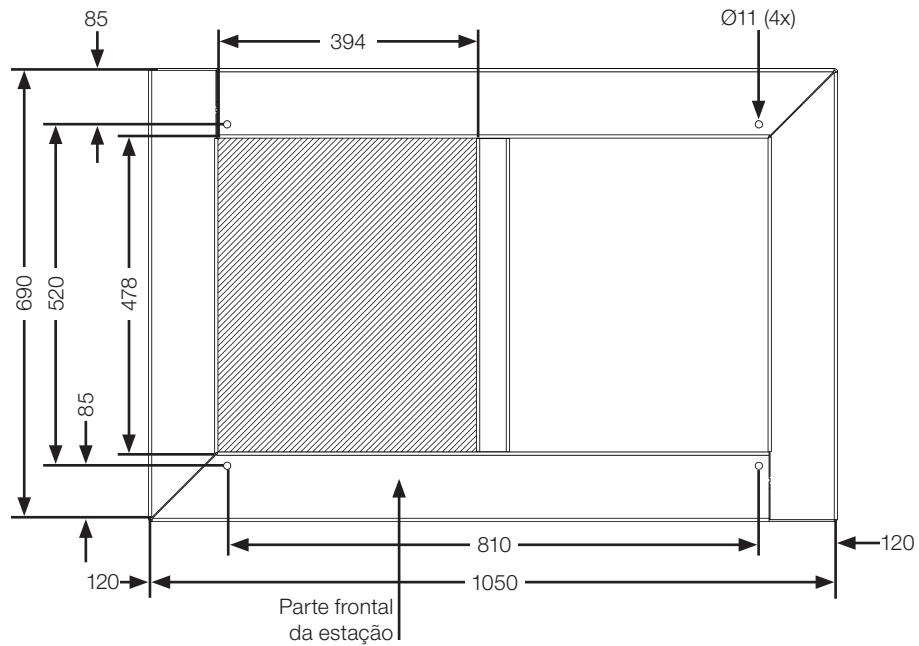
Dimensões para fixação e passagem dos eletrodutos da WEMOB-STATION - mm
